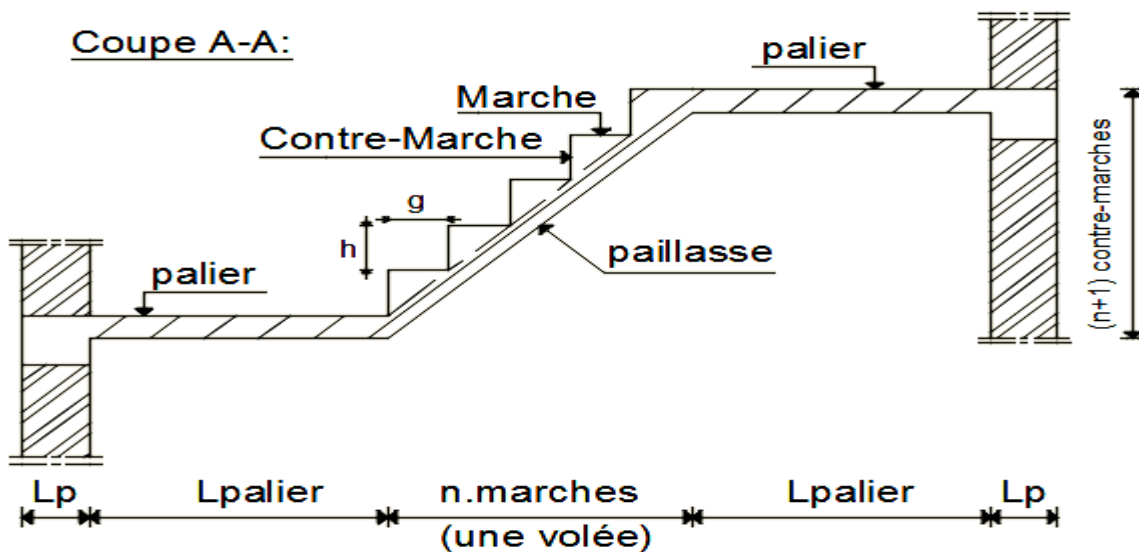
N°02 : Coupe sur la cage d'escaliers.
